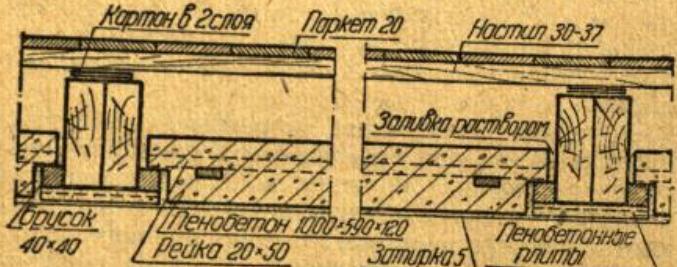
Междуэтажное перекрытие Техпроекта с накатом из пенобетонных блоков.
